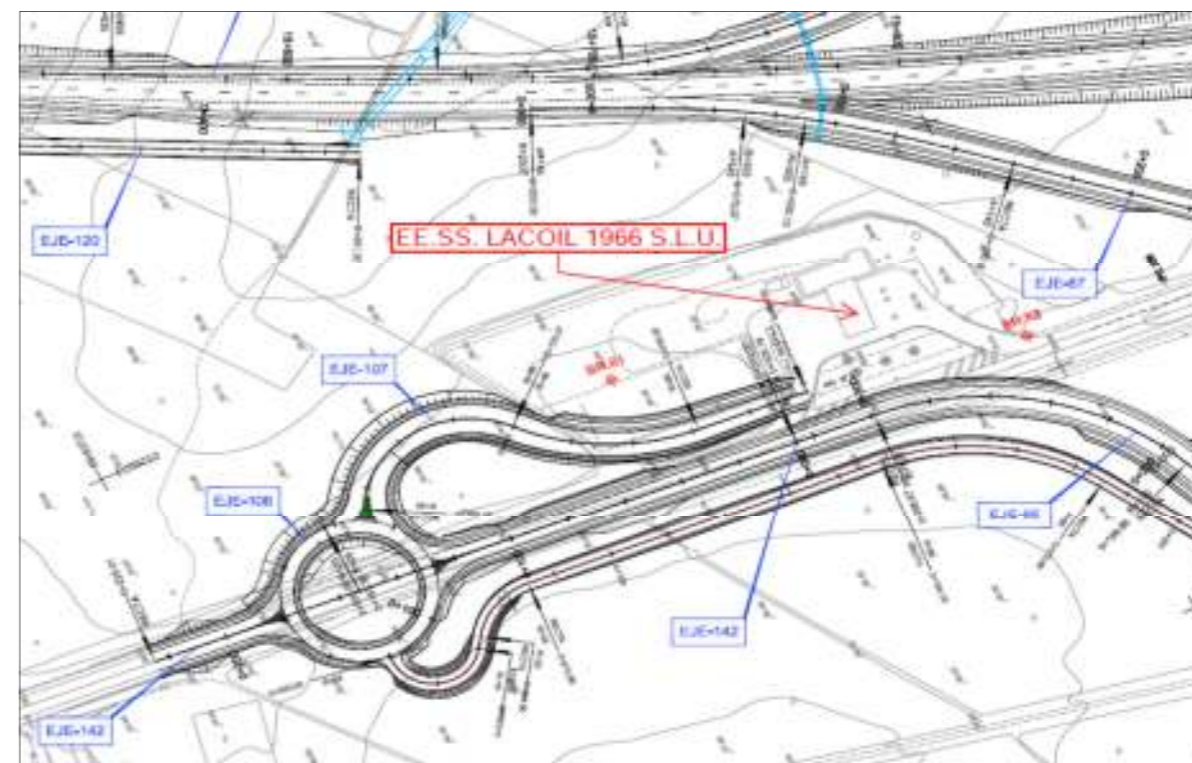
Propuesta vigente de entrada a la EE.SS. Lacoil 1966 S.L.U.
